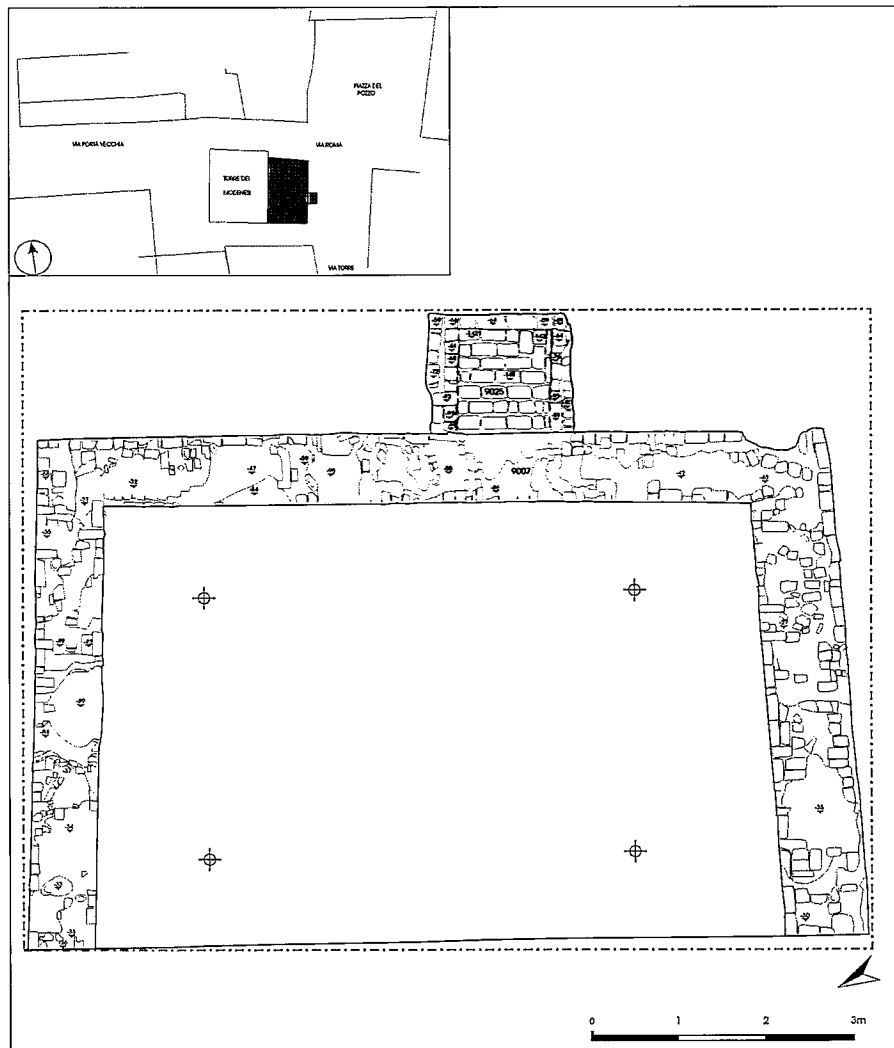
Il perimetro dell'edificio trecentesco addossato al prospetto est della Torre con il vano quadrangolare (USM 9007-9025).
